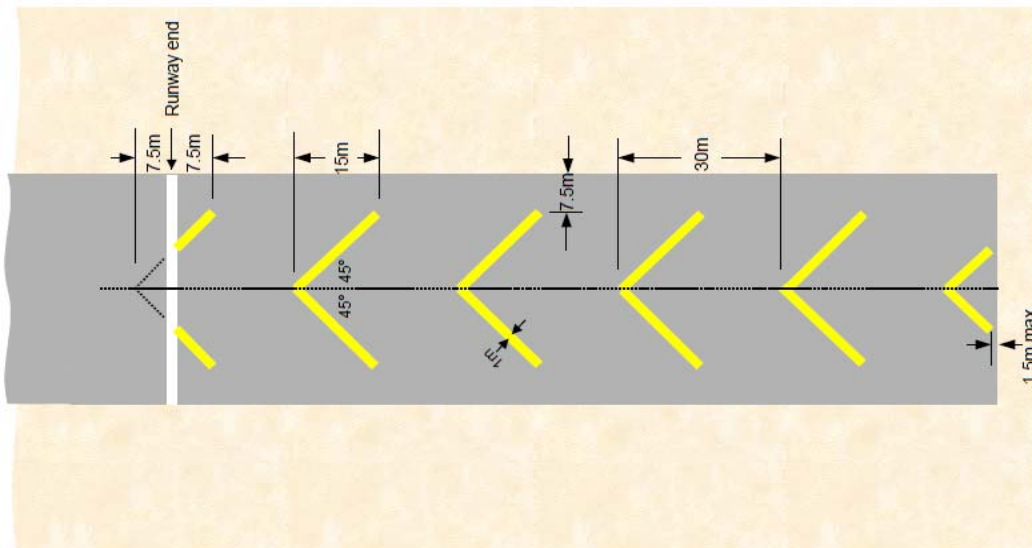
Vijëzimet përpara fundit të pistës
